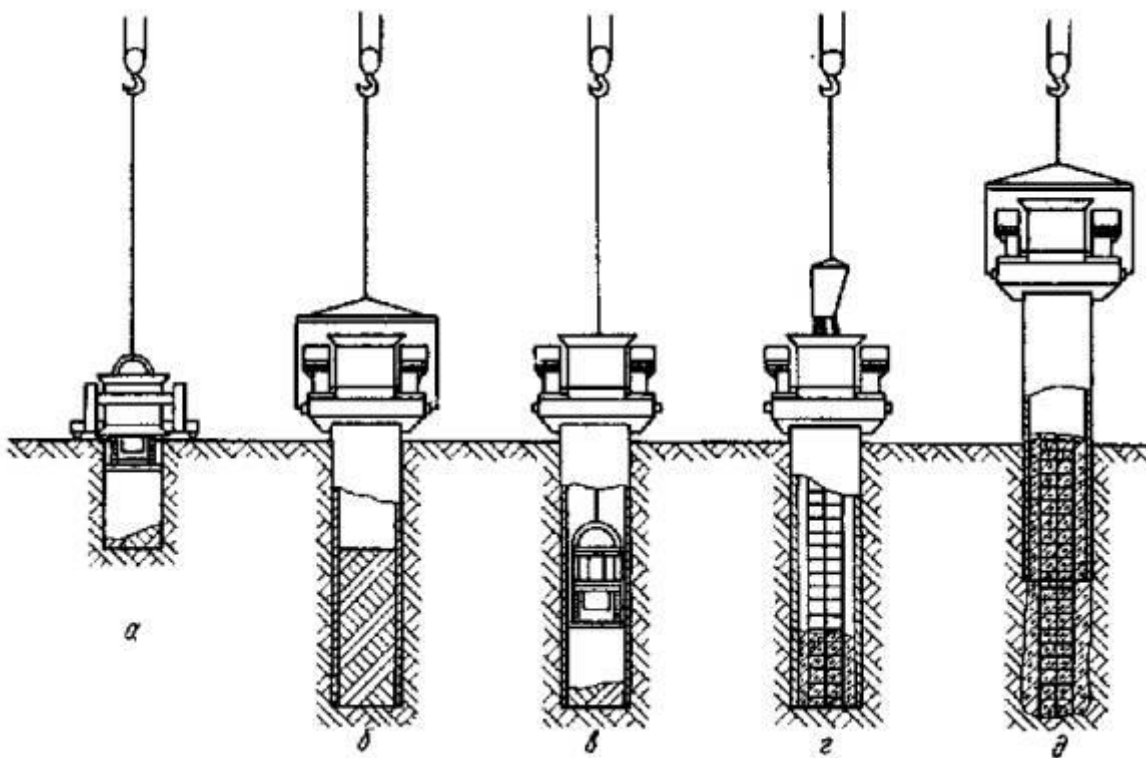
Технологическая схема изготовления набивных свай с выемкой грунта под защитой обсадных труб на полную длину свай:
